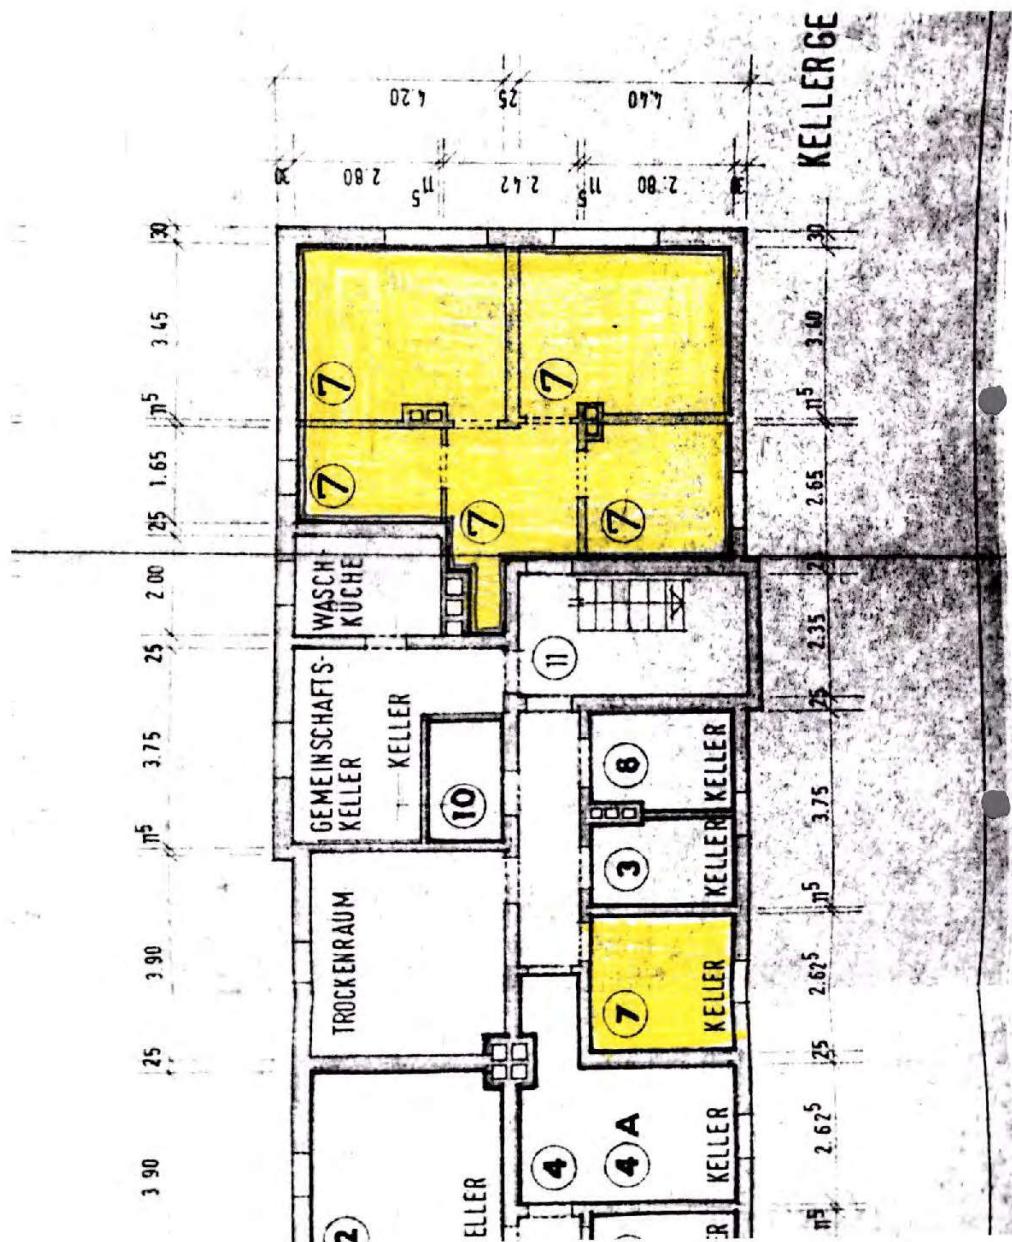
Teilgrundriss KG mit Kennzeichnung zugehöriger Kellerräume
